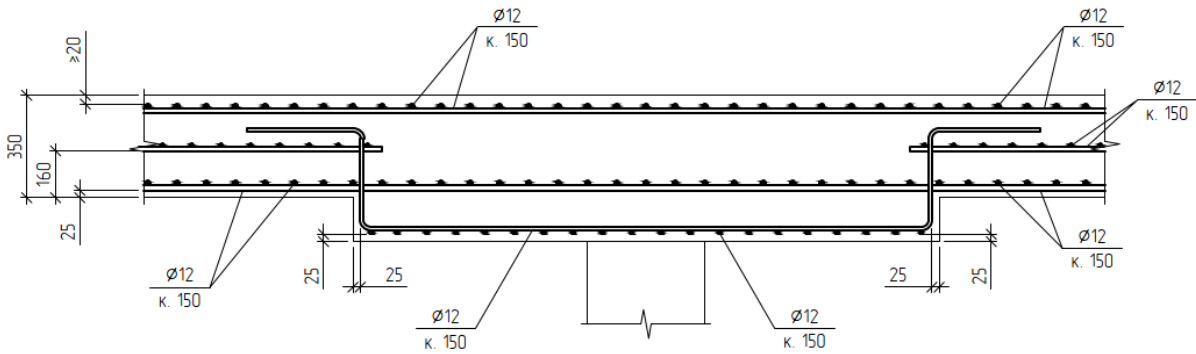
Принципова схема армування плити перекриття ПРУ
